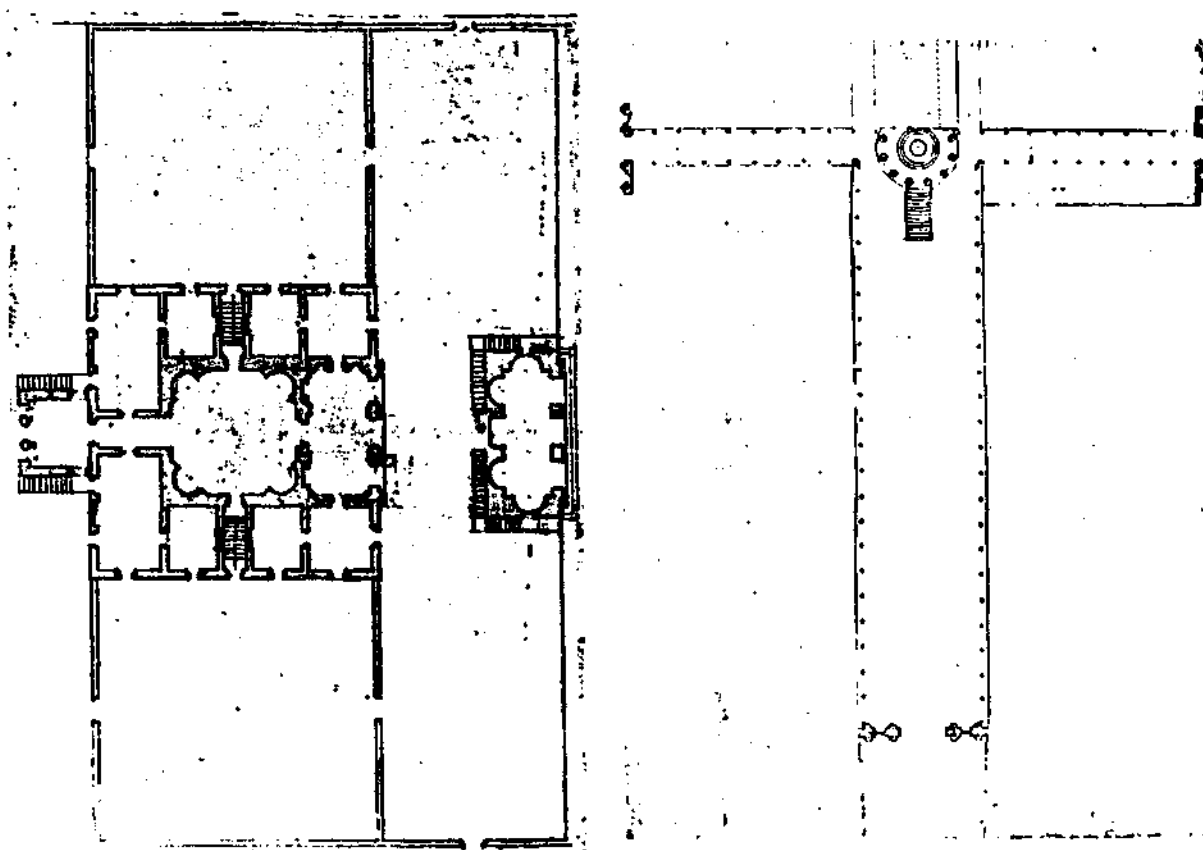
Edificio de planta central (RIBA.XVI.19.b), atribuido a Palladio.
